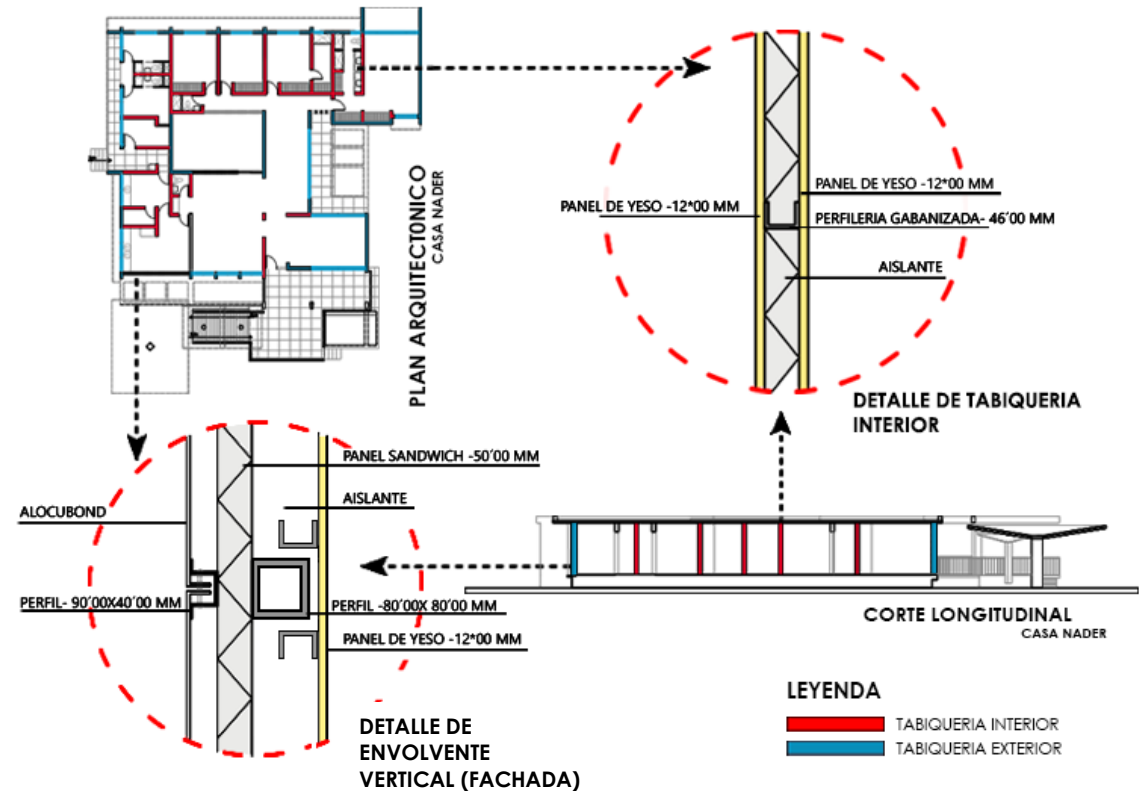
Sistemas constructivos de cerramiento para muros exteriores e interiores en modelo 2 Nader. Fuente: Elaboración Propia
